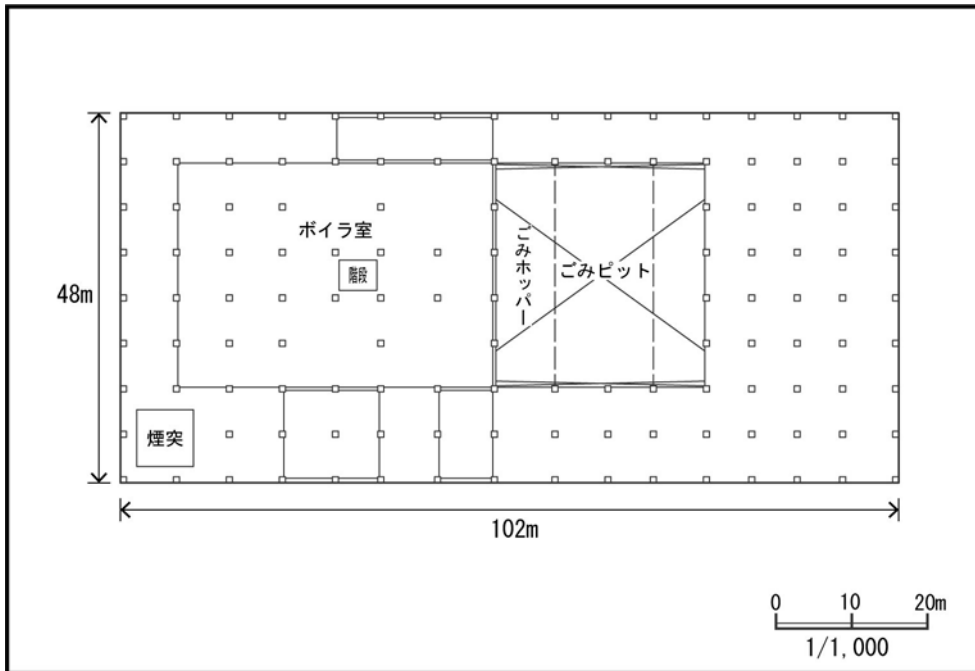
(6) 新施設の平面図（新焼却処理施設 5 階）
